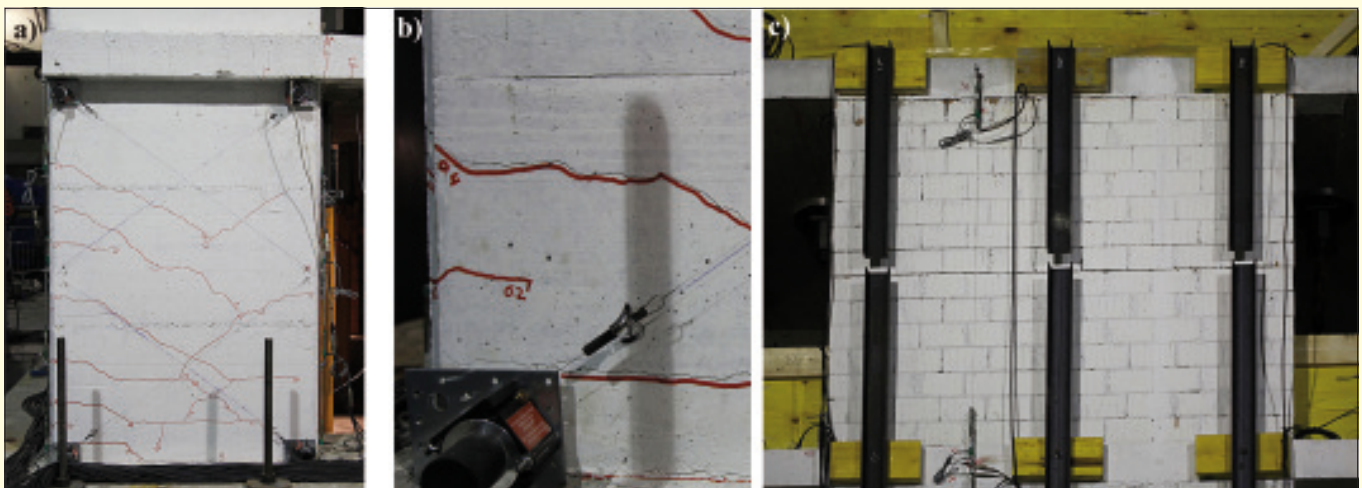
Fuß der Stahlbetonwand (a, b) und Mauerwerkswand des obersten Geschosses (c), die senkrecht zu ihrer Ebene beansprucht war, nach dem letzten Versuchsdurchlauf.
